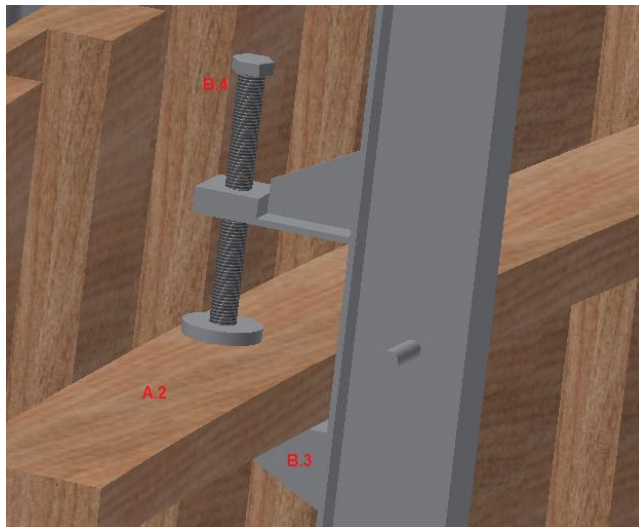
Instalación de Caballete en cara exterior junto a Viga Travesaña
